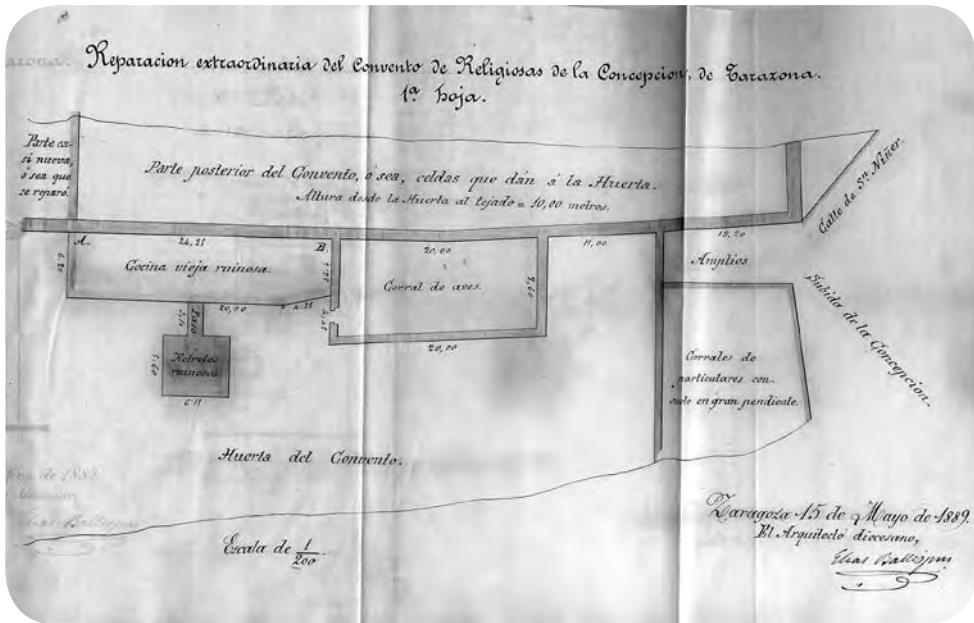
Planta. Proyecto de reparación de los excusados del convento de la Concepción de Nuestra Señora, arquitecto Elías Ballester, 1889. Plano A.D.T.
